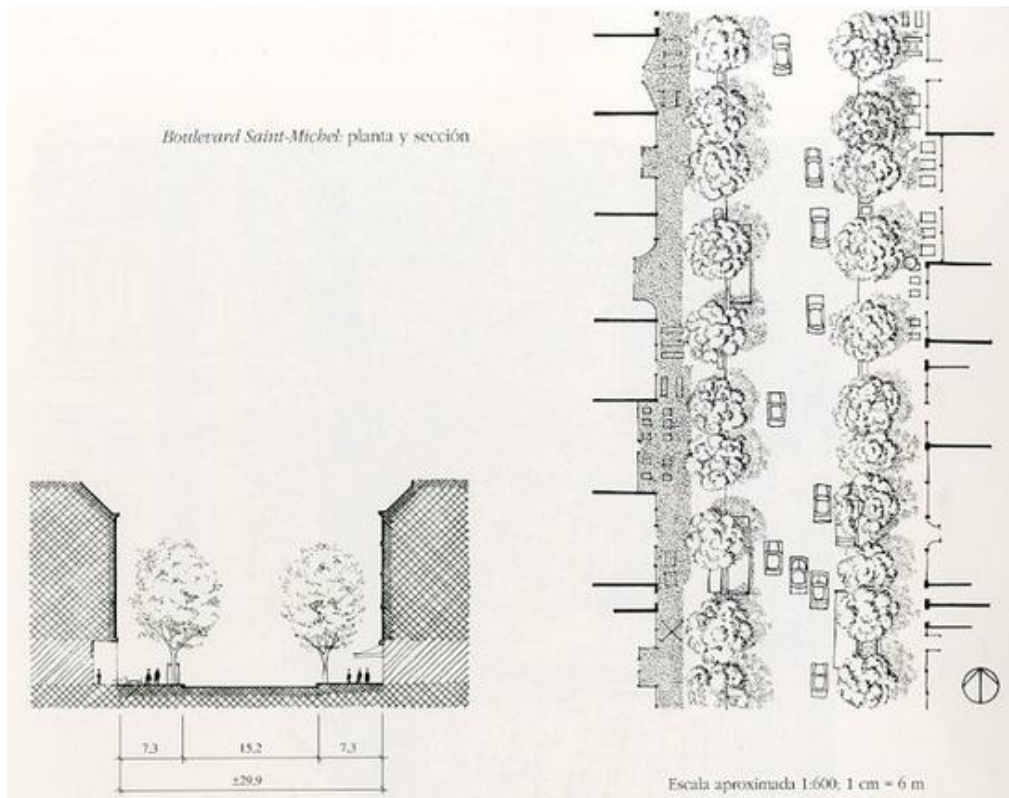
Boulevard Saint-Michel planta y sección.* Fuente: Jacobs, A. B. 1996: 69.
